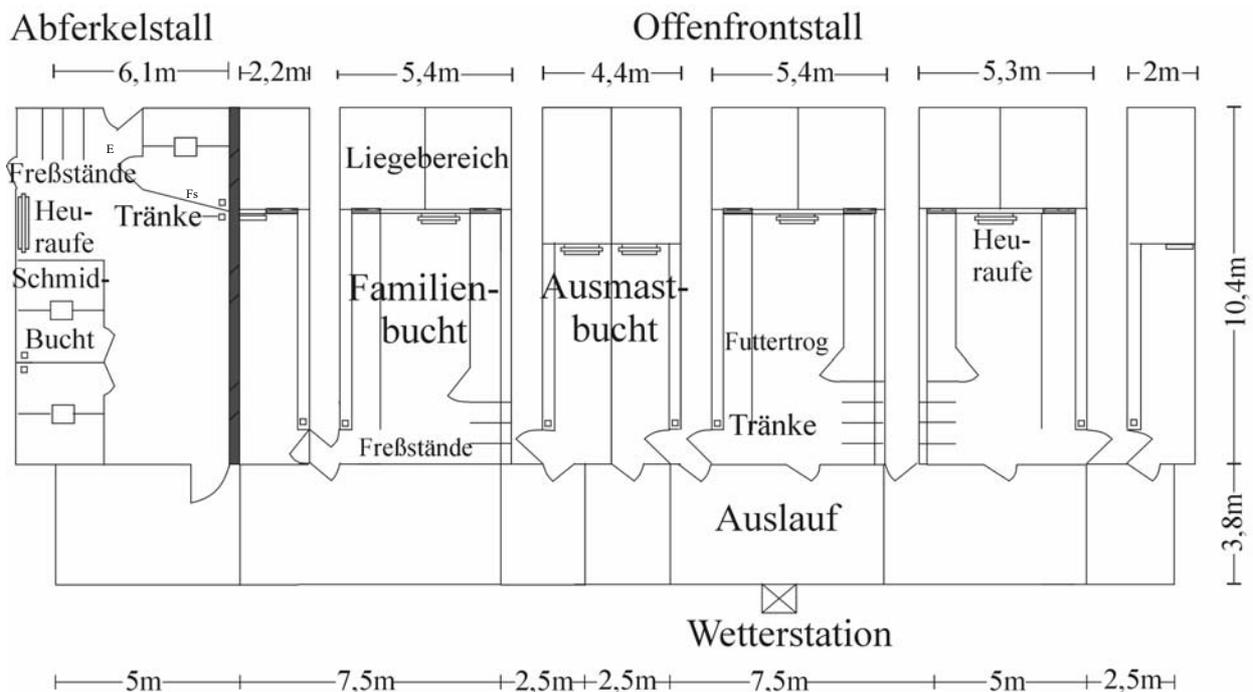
Grundriss des Offenfront-Stolba-Familienstalles in Laab im Walde
